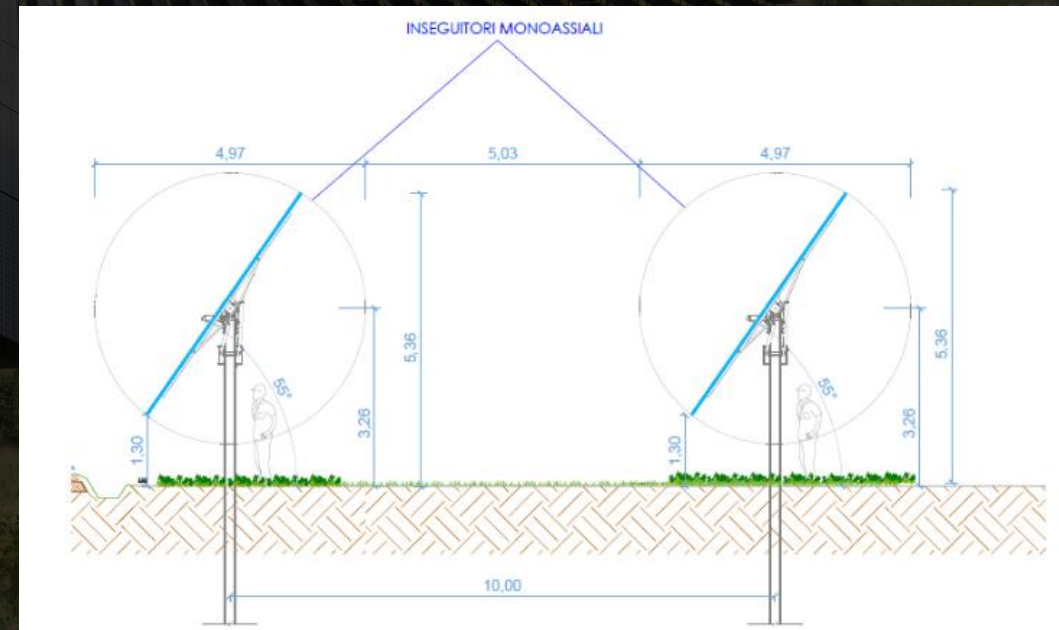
Vista in sezione laterale della struttura tipo, con altezze minime e massime raggiunte dai moduli
